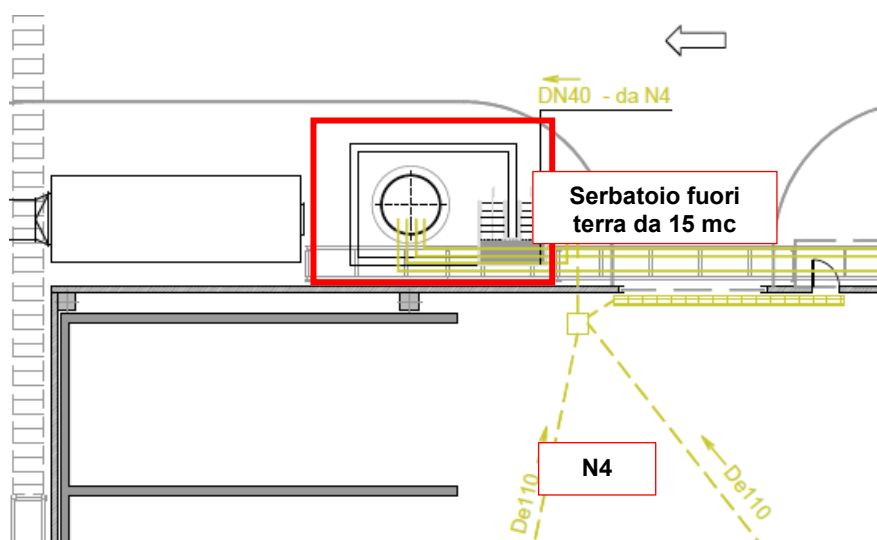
Serbatoio stoccaggio acque di lavaggio e processo (stralcio CO 05 RA AA 01 DT PL 03.02)
